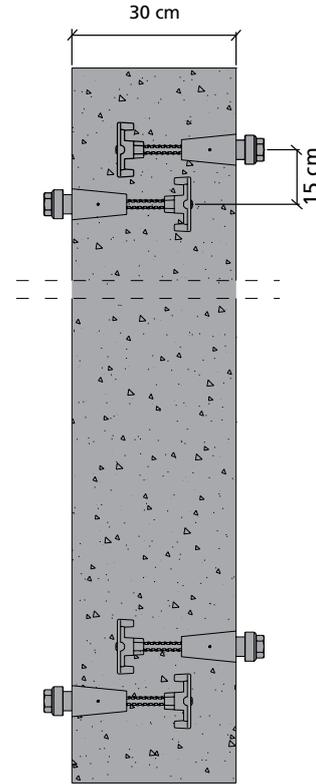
Grundriss für beidseitige Kletterbühnen
